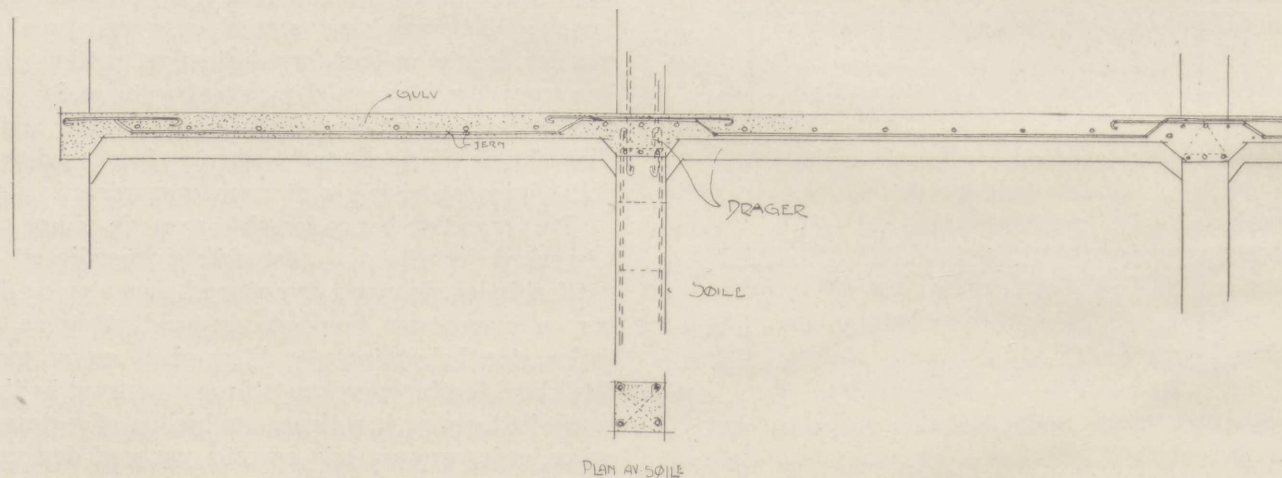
Armeret beton anvendt som gulv, dragere og søile.
